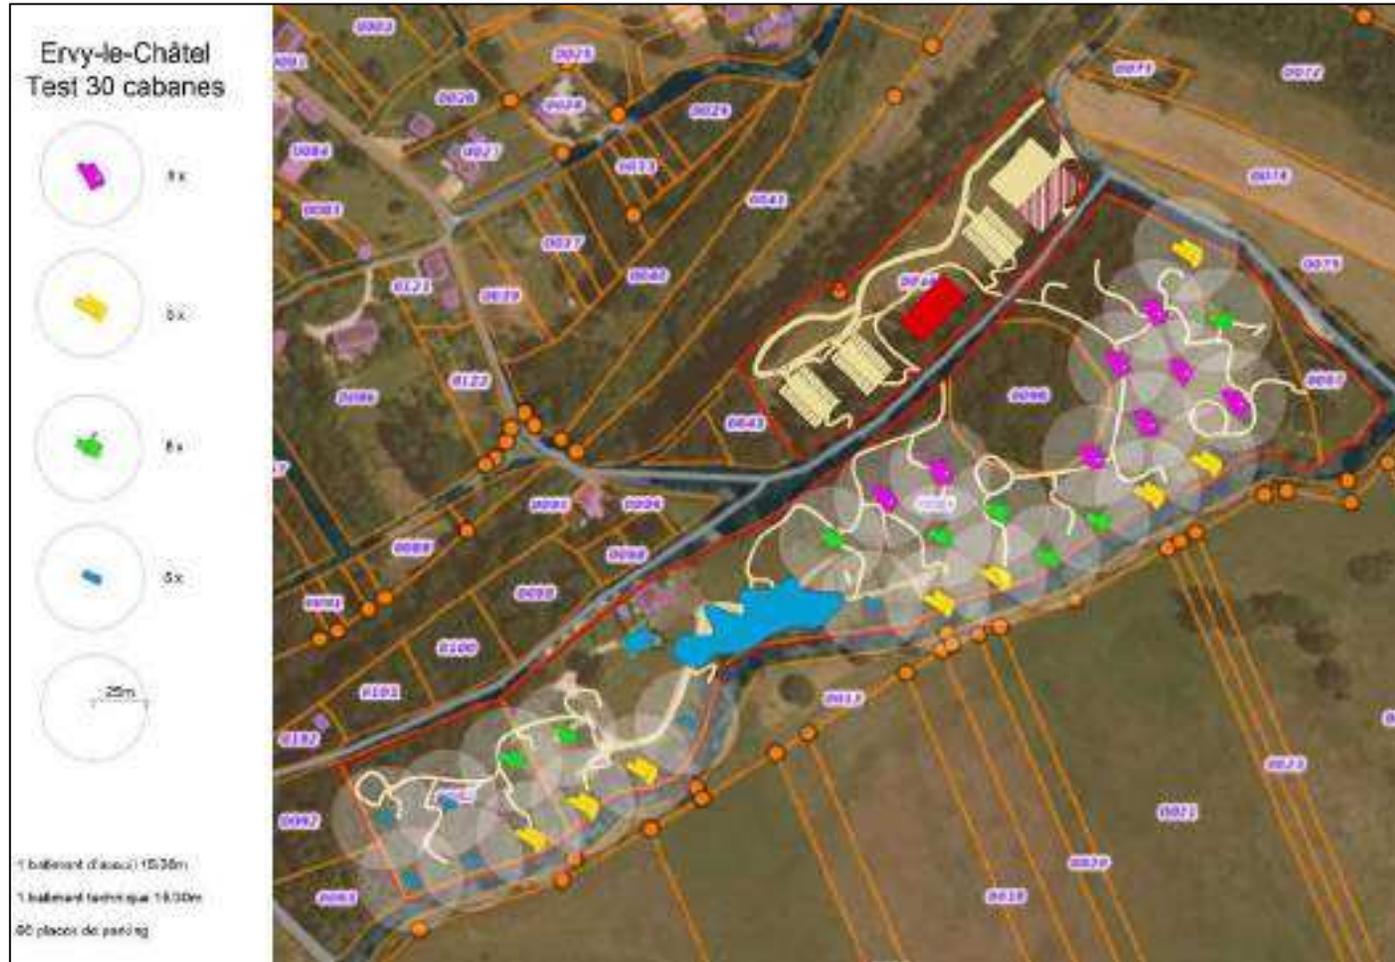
Plan de masse version 1 (Source : NUTCHEL)
